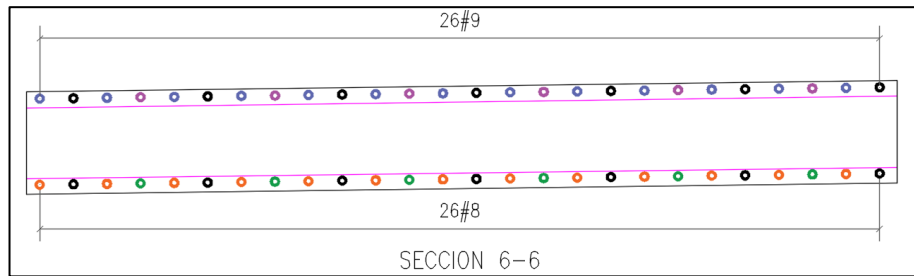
Refuerzo suministrado corte 6-6 – FIN
